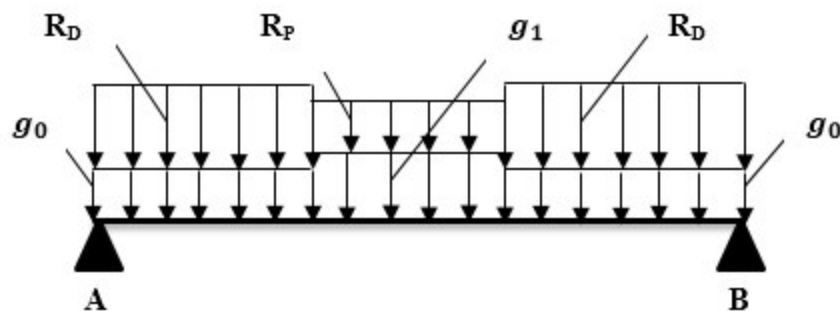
Schéma statique de la poutre brisée de l'escalier.
